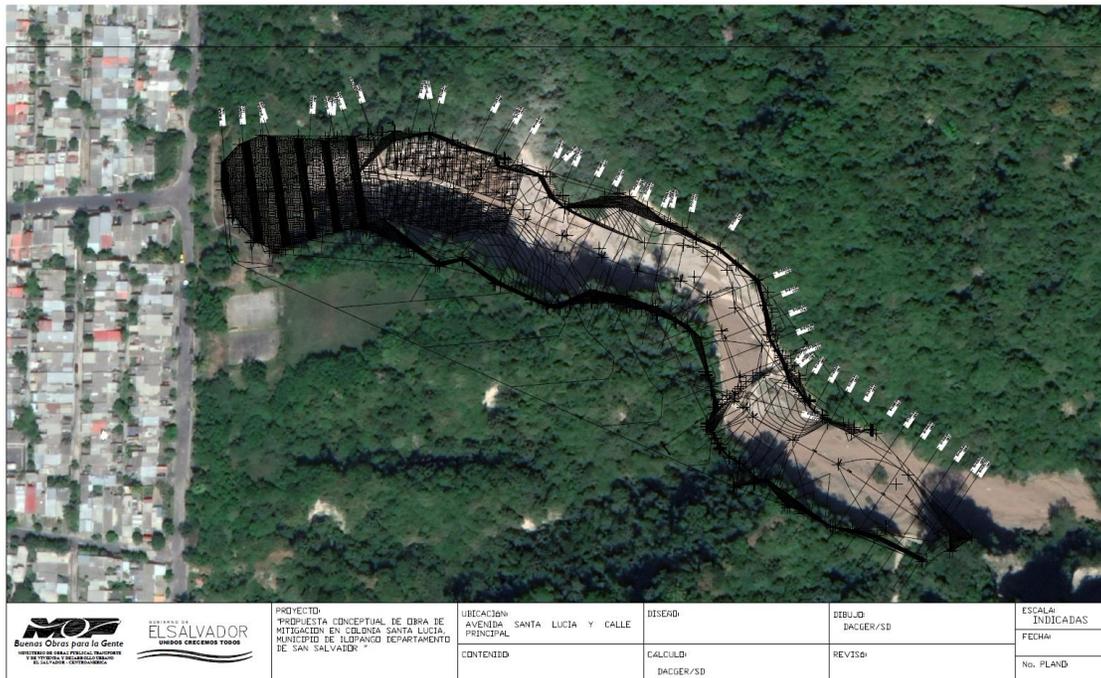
Planta del alineamiento considerado para la cárcava Santa Lucía. El área achurada detalla la intervención dentro de los límites de la cárcava y el cauce de la quebrada.
